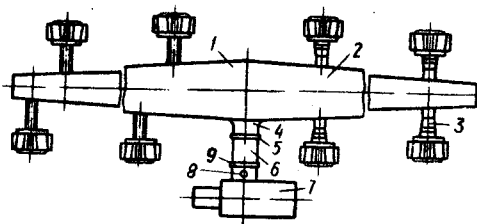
Установка для підігрівання повітря: 1, 2 — повітроводи; 3 — патрубок; 4 — конфузор; 5 — сітка; 6 — приставка; 7 — калориферний агрегат; 8 — випускна труба; 9 — заслінка
